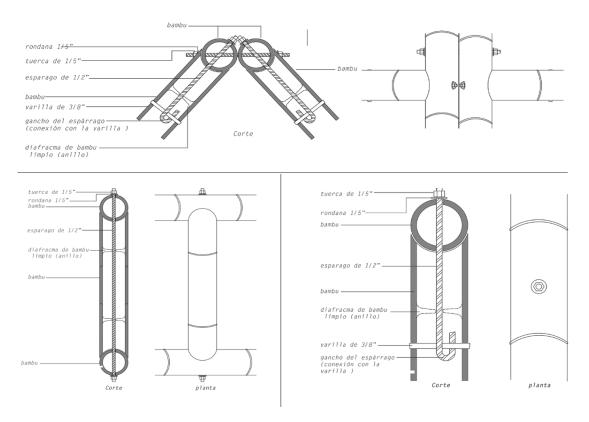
Detalle uniones de bambú utilizando espárragos metálicos
